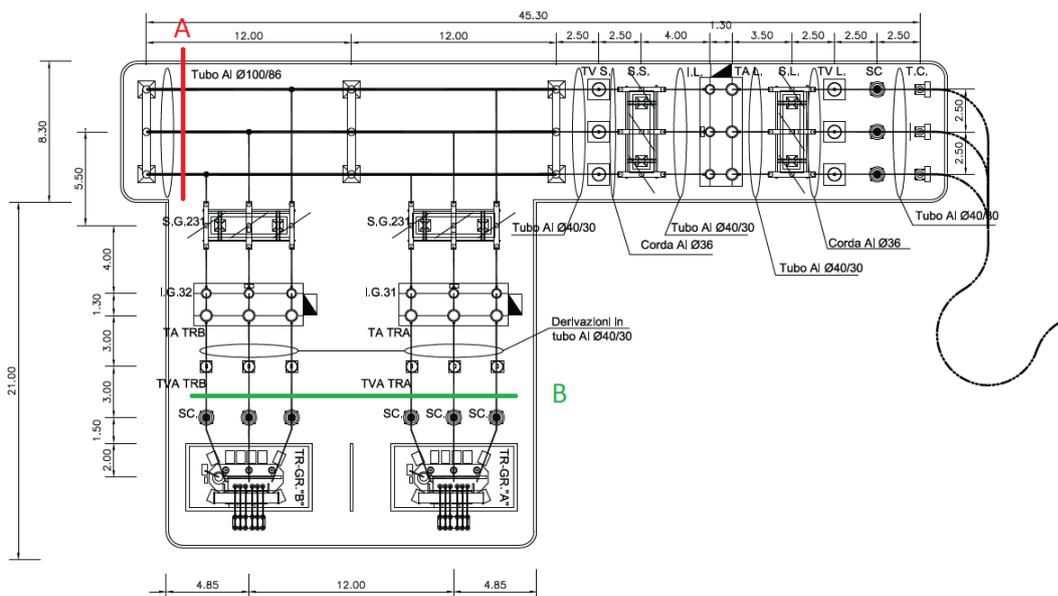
Planimetria del piazzale di SSE con indicazione delle sezioni A e B
